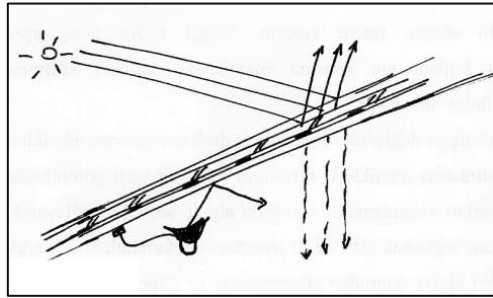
Renzo Piano Building Workshop çalışma mekânlarından biri, (URL-23)
